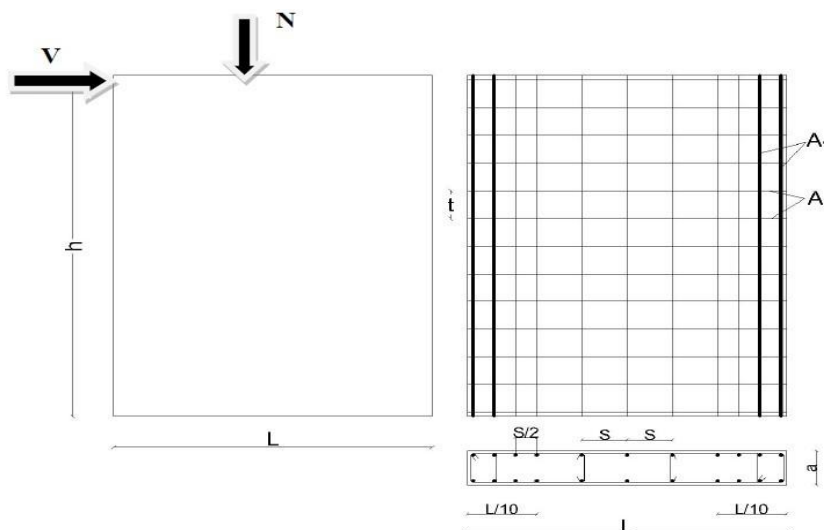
Schéma d'un voile plein et disposition du ferrailage.
